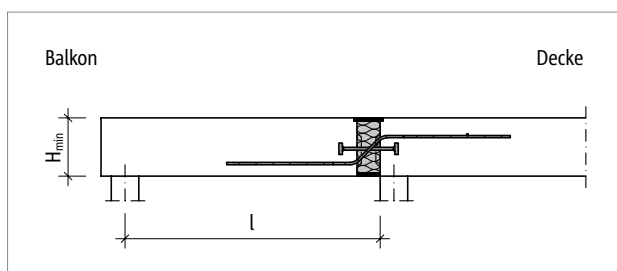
Schöck Isokorb® T Typ QP: Statisches System
